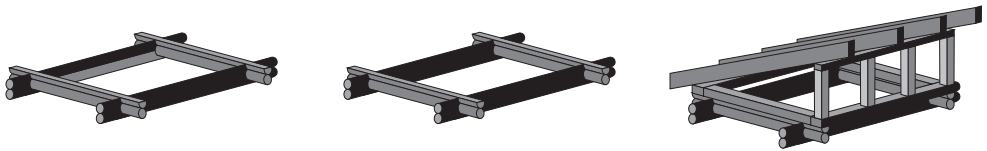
Перекрытие под кровлю с установкой отдельного каркаса
